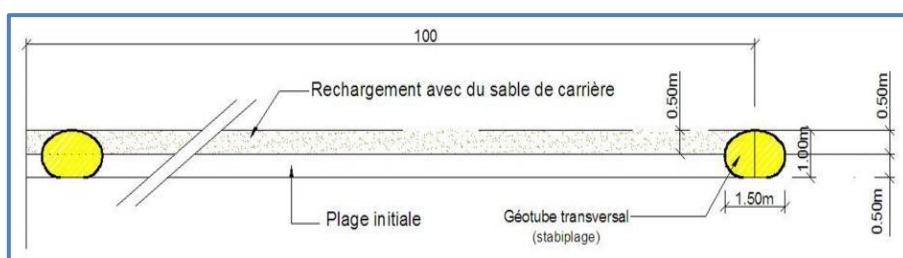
Coupe longitudinale de la plage : implantation des stabiplages
